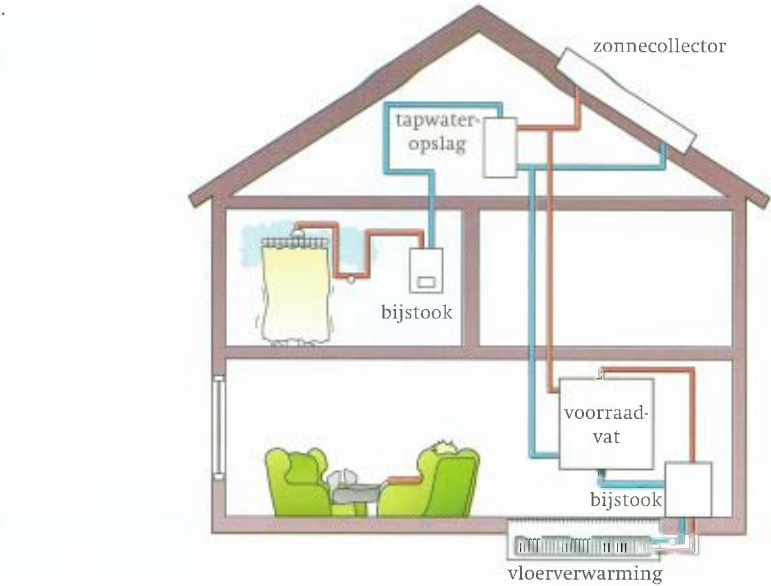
Schema warmwatervoorziening met zonnecollector.
